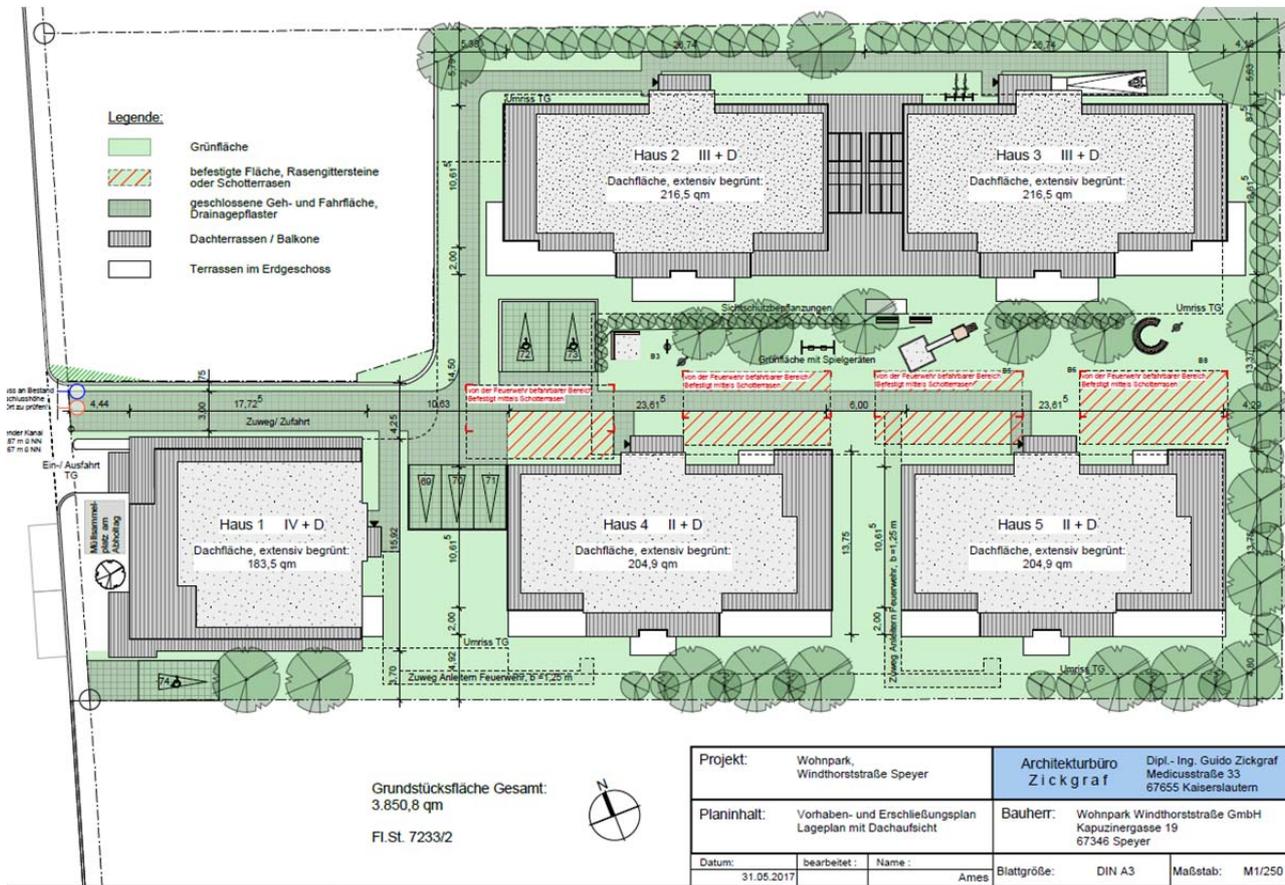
geplantes Vorhaben – Lageplan, Dipl. Ing Guido Zickgraf, ohne Maßstab
